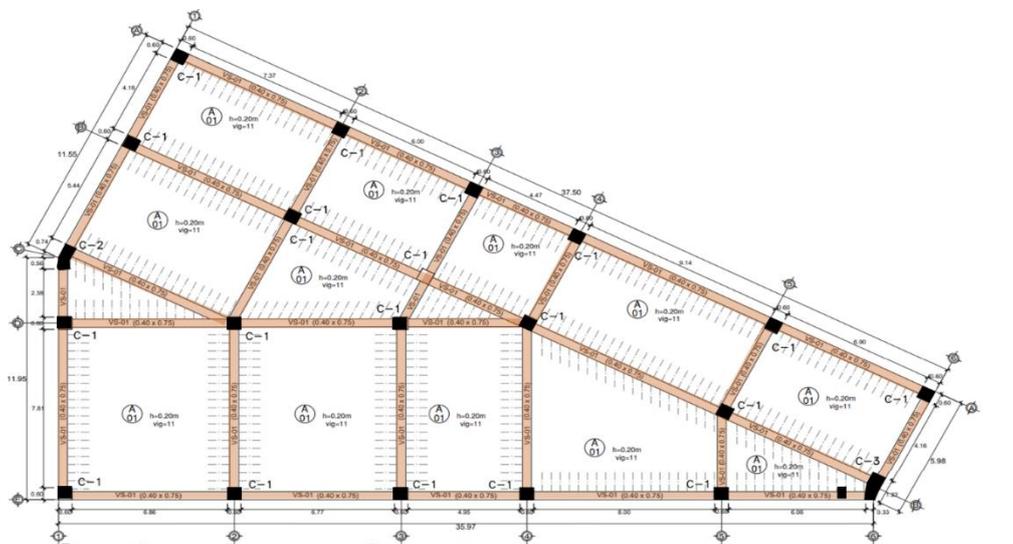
Diseño de Losas III Ver plano E04_Plano de Estructuras de Cafetería, Elaboración propia
